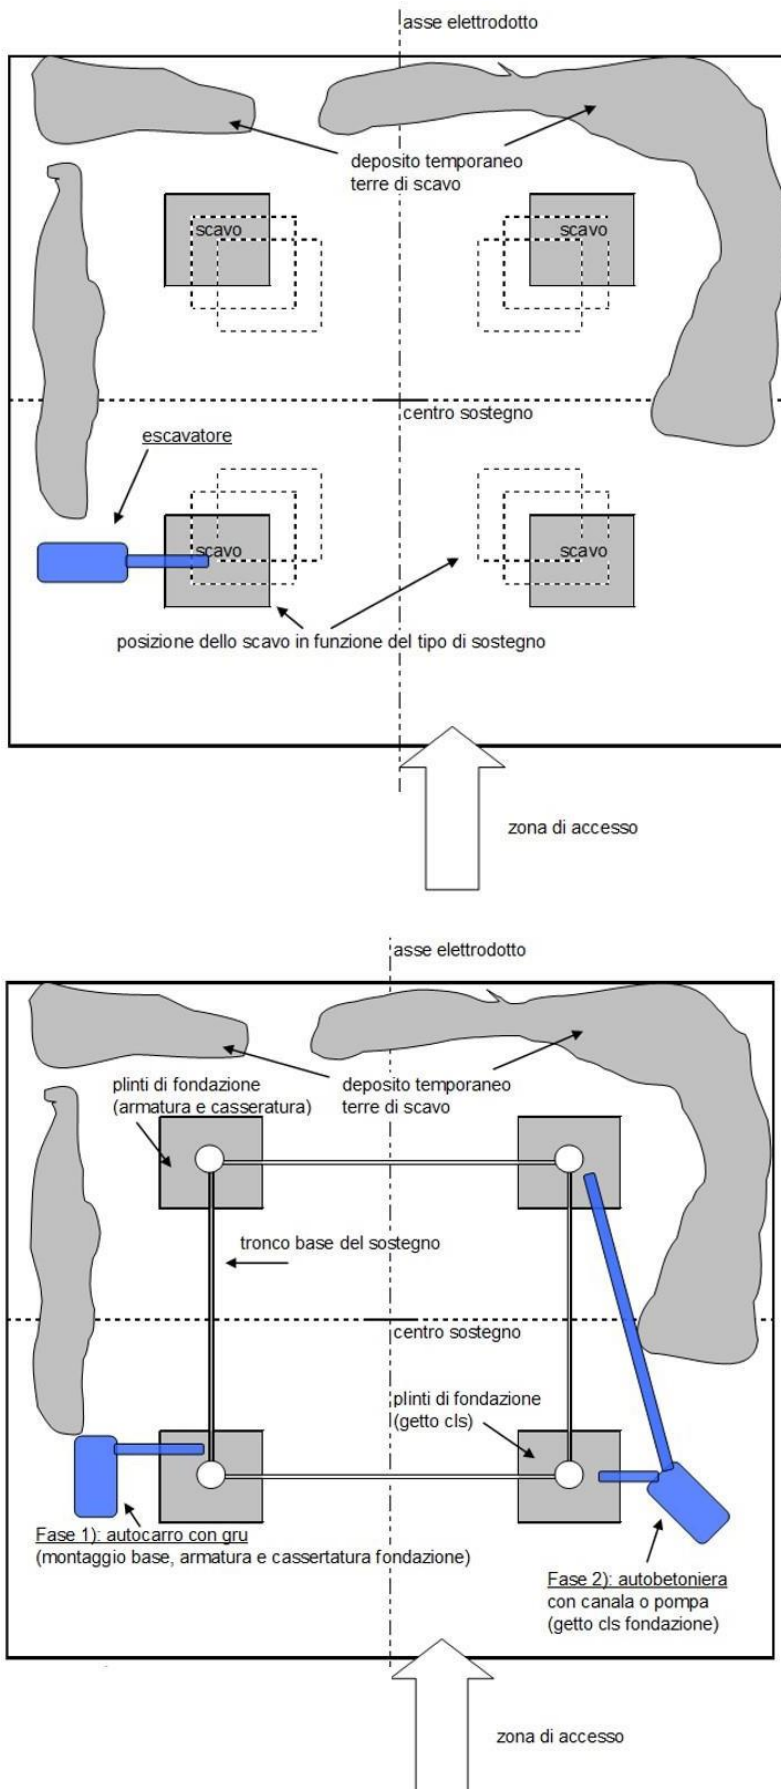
Planimetria dell'Area Sostegno (montaggio sostegno) - Planimetria dell'Area di linea – Tipologico
